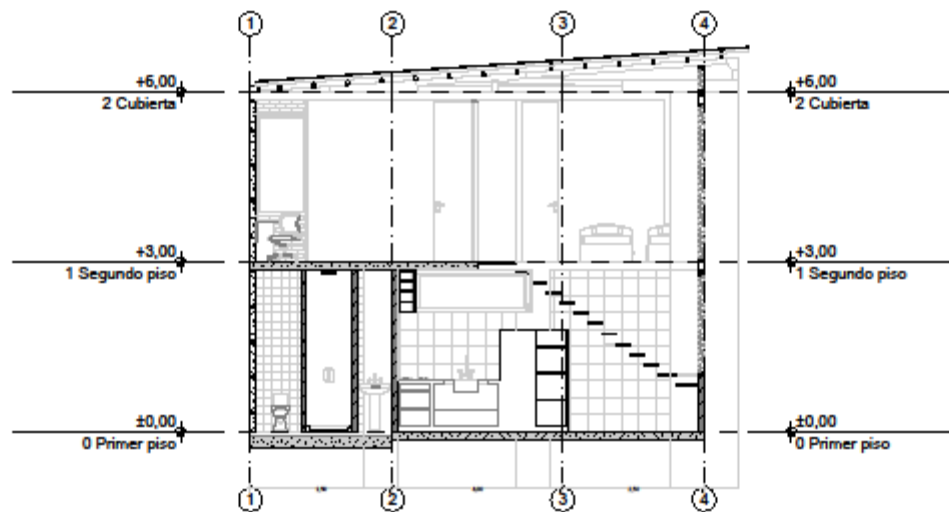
Tipo C. Cortes C-3 y C-4. Esc.: 1:100
